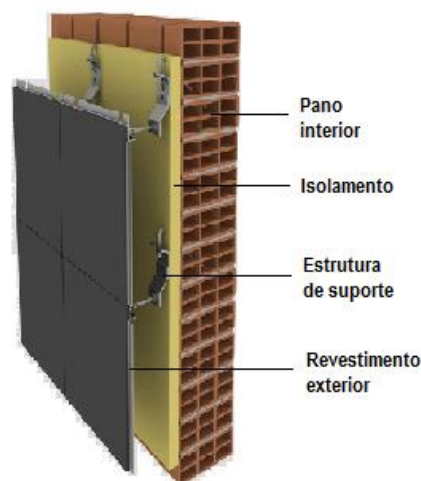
Constituição de uma fachada ventilada. Fonte: adaptado [47]
